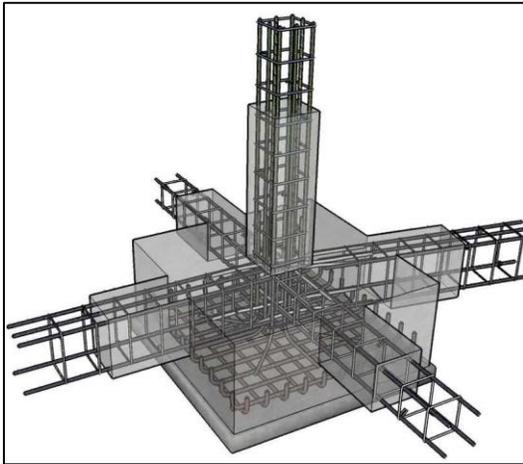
Tipología de Cimentación. Fuente: Ingeniería y estructuras. 2015. Tipos de cimentaciones. Recuperado de: www.youtube.com/watch?v=WkMcwZyWKjg.
